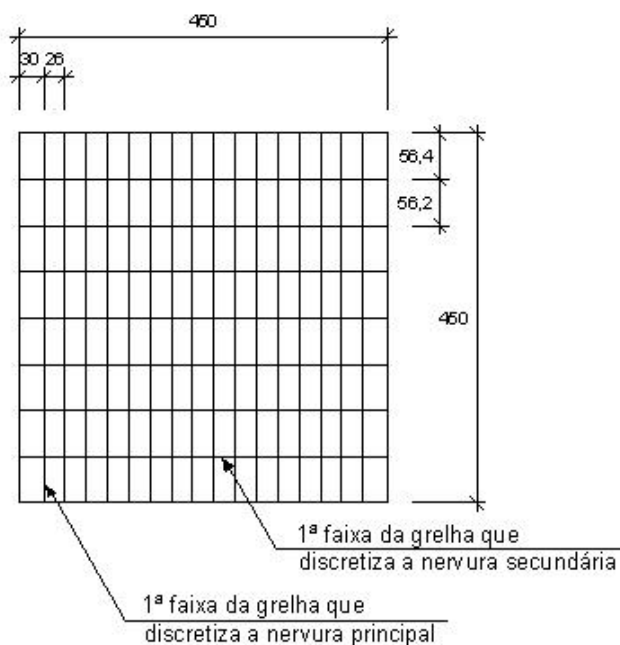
Posicionamento das primeiras faixas que discretizam a laje nervurada
